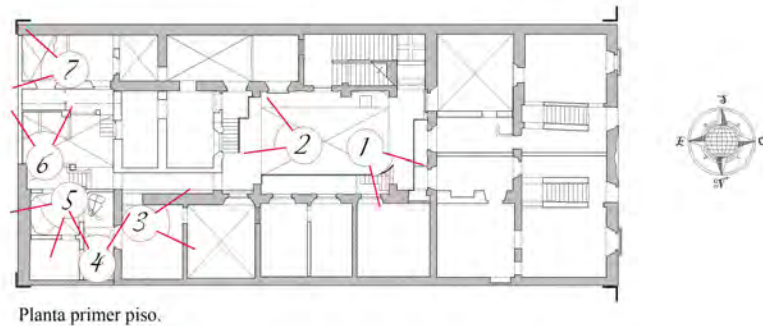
Levantamiento de Planta primer piso de Jesús María (Santiago, 2016).
